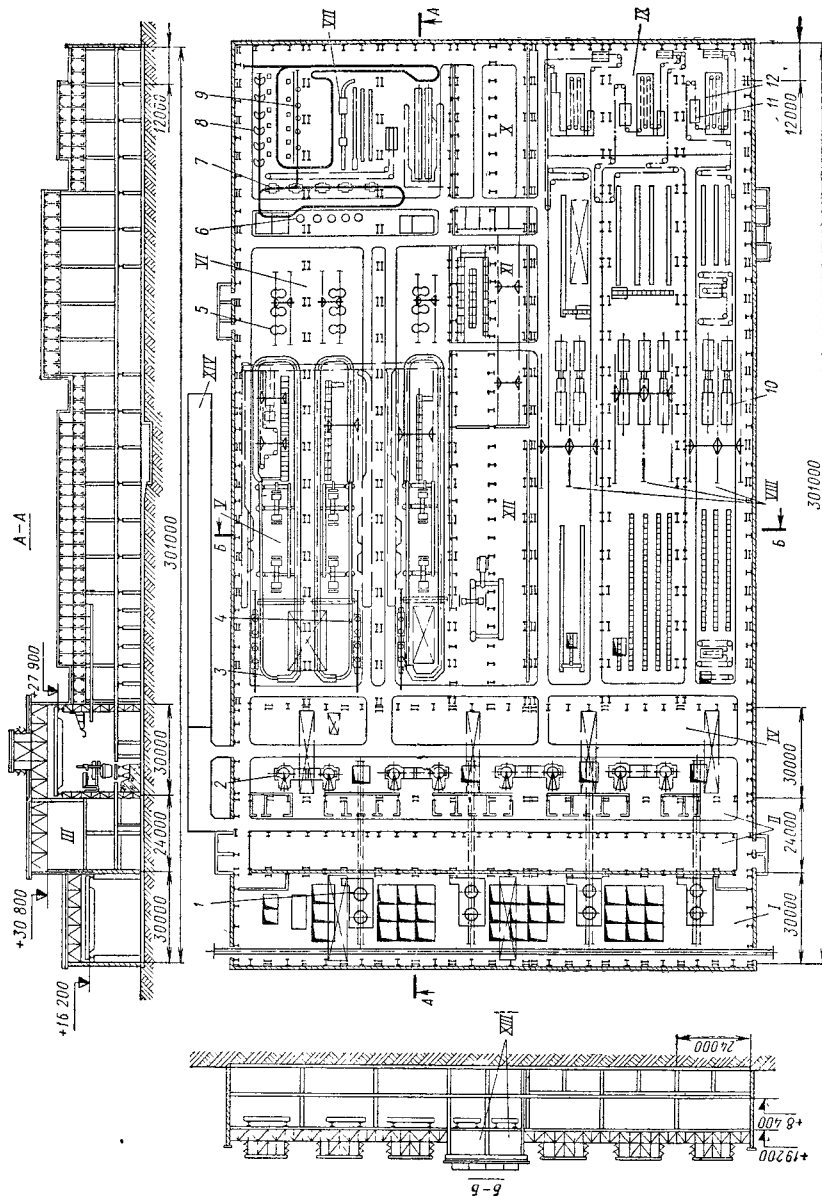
Двухэтажный цех стальных отливок для автомобилестроения:
